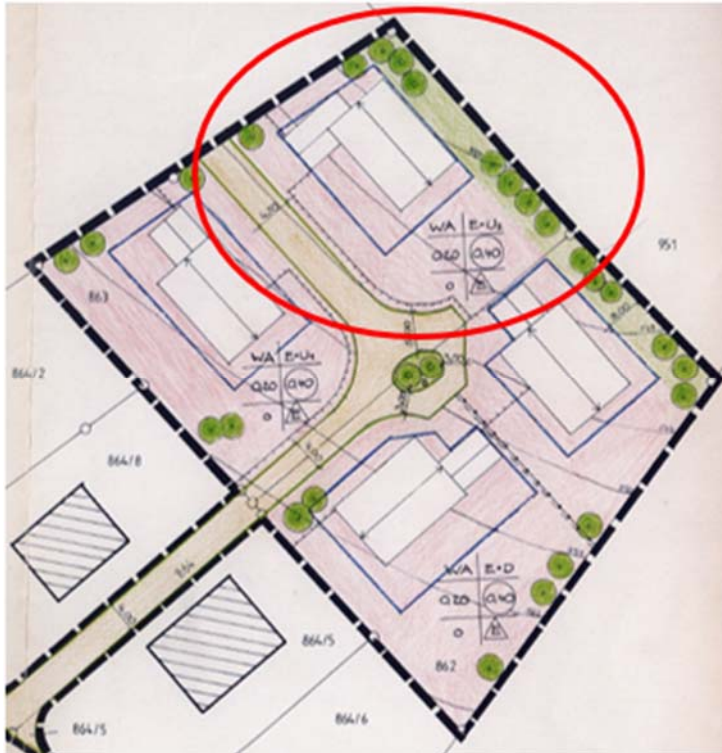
Auszug Bebauungsplan „MESSNER FELD I“, Quelle: Bebauungsplan „MESSNER FELD I“
